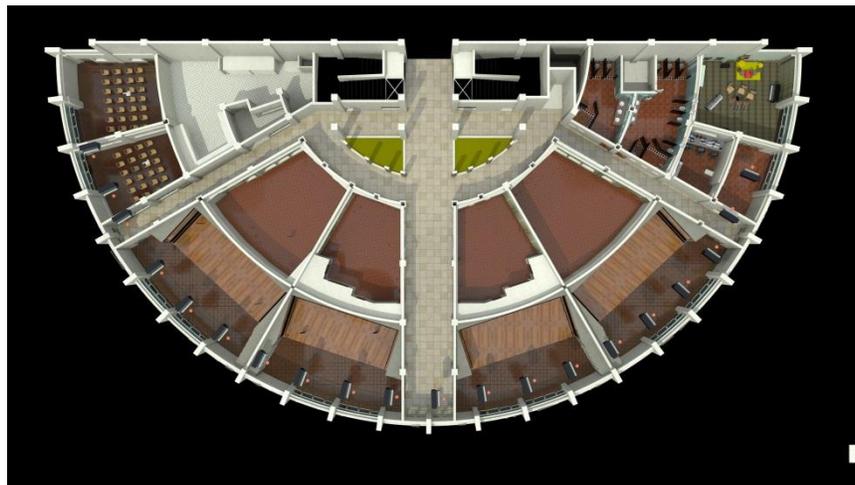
Primera planta. FUENTE: elaboración propia.
